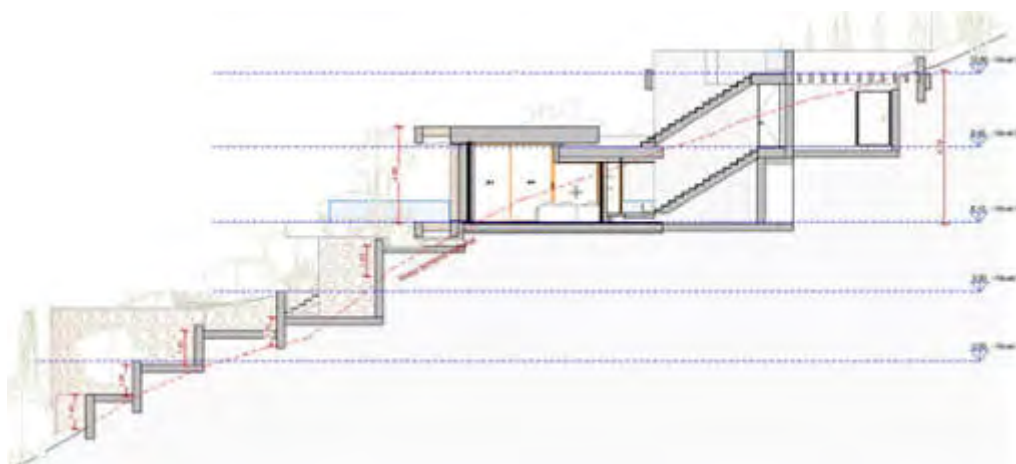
SECCIÓN TRANSVERSAL POR ESCALERAS N.0 A N1 Y DE N1 A N2(CUBIERTAS)
